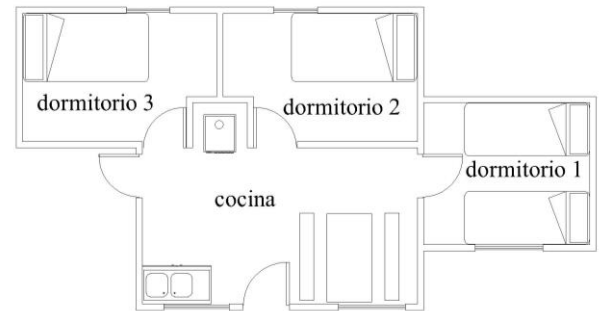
Planta de la vivienda entregada actualmente por el subsidio básico rural.
